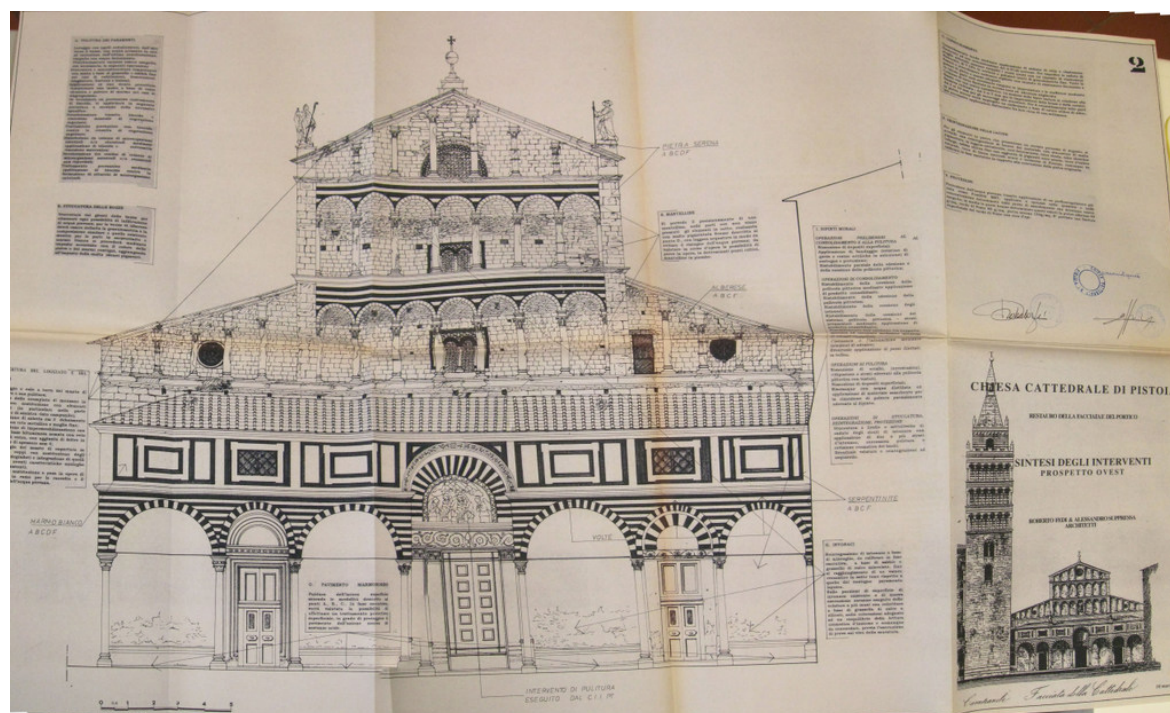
18: Tavola del progetto preliminare dell'intervento di restauro 1999-2000. Coll. A1/20.
